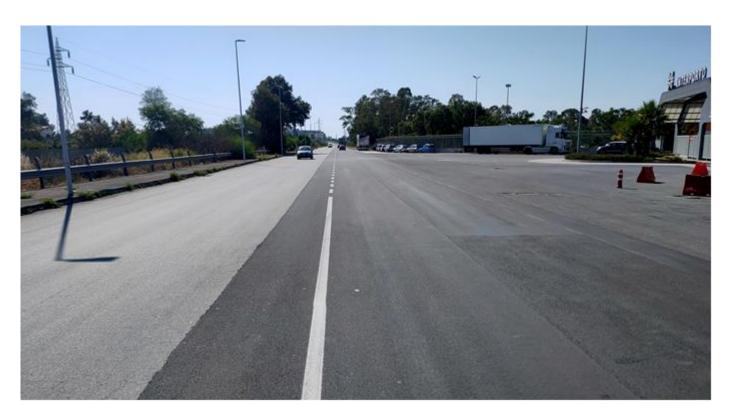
Tratto stradale interessato dalla realizzazione dell'intervento
